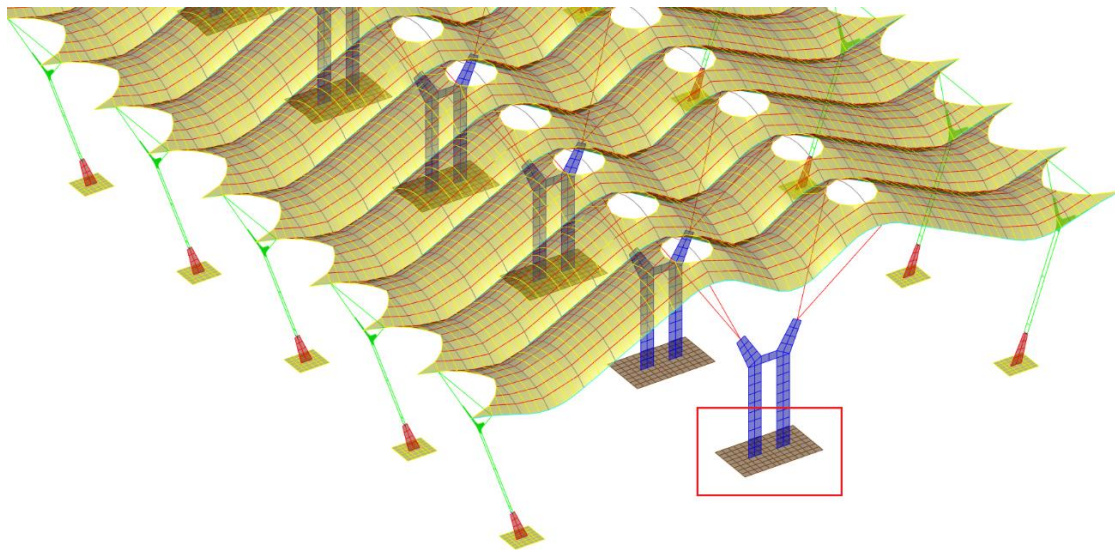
| Captura de SAP2000: Zapatas de los pilares interiores de hormigón armado. (elaboración propia)
